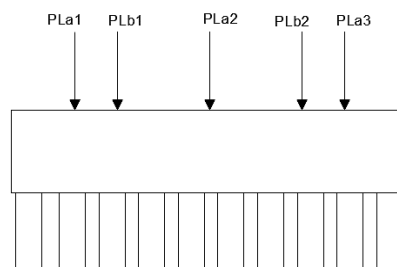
Ubicación de las cargas vivas vehiculares para pila 1.
